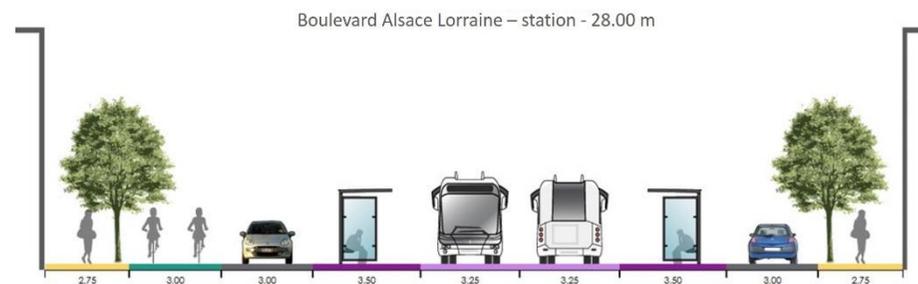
Coupe 2-2 projet – boulevard Alsace Lorraine - station
